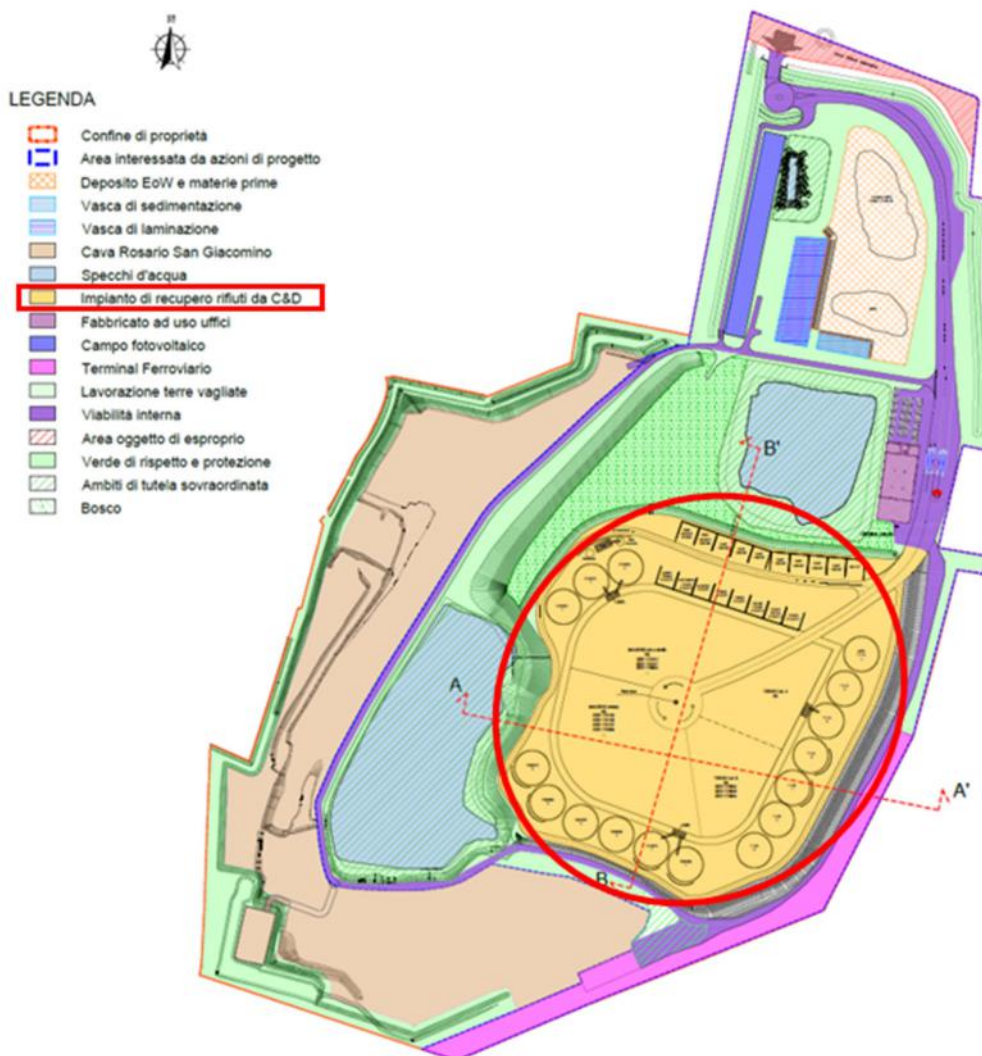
Individuazione impianto di recupero rifiuti da C&D (stralcio Tav. PF T11)
